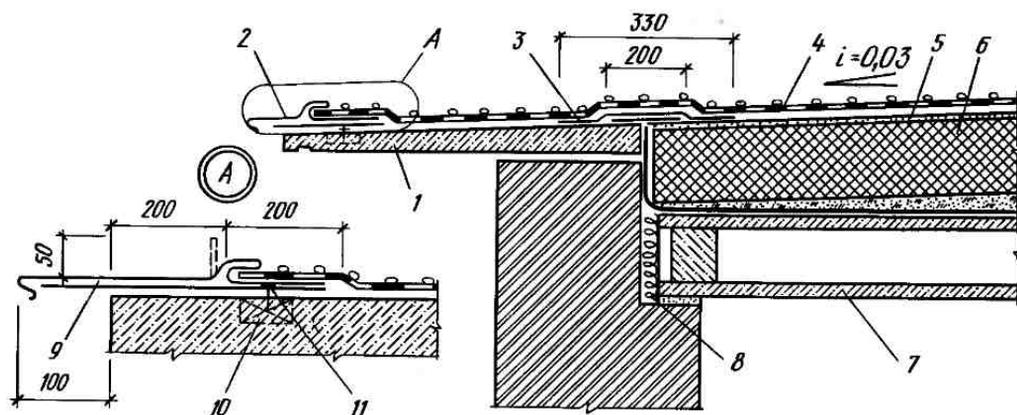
Конструкция карнизного узла здания с совмещенным покрытием и наружным неорганизованным водоотводом с крыши:
